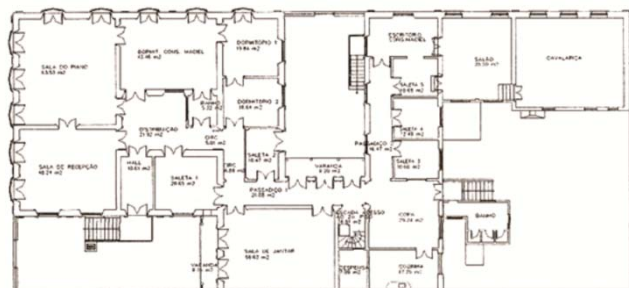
Croqui de la planta baja del Casarão 8. (Fuente: Peres, 2008).
